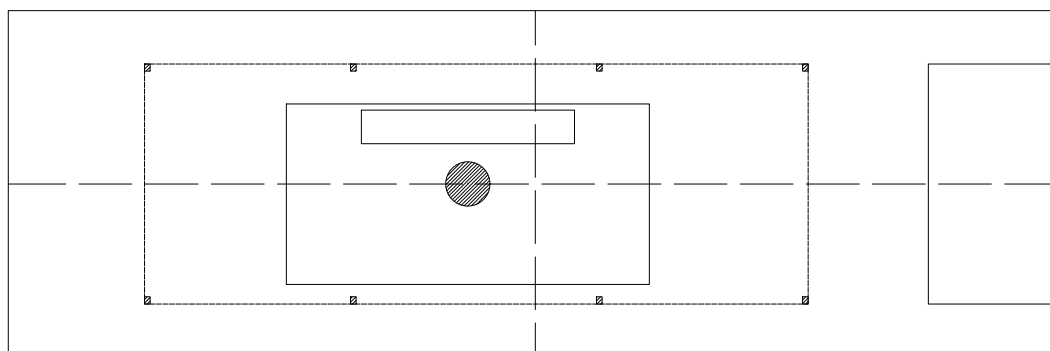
Diagrama de eixos, planta piso térreo casa de Blas (Ilustração nossa, 2018).
